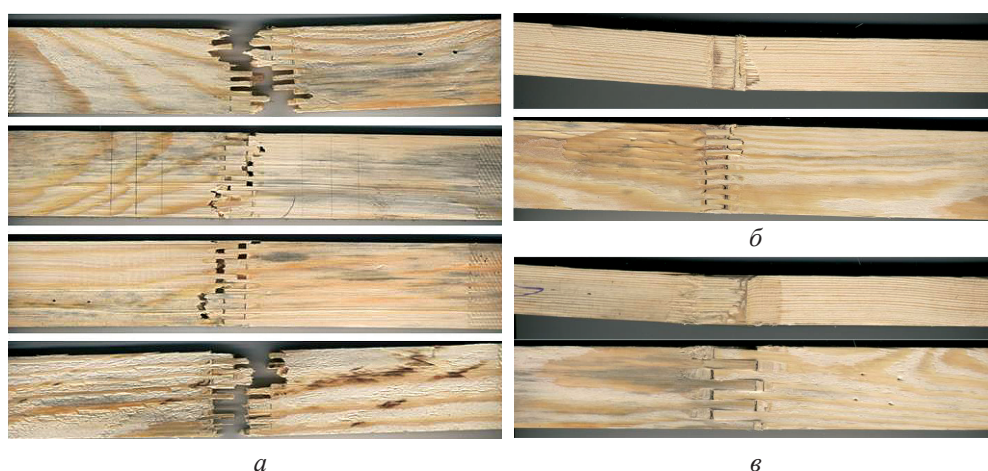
Примеры разрушения образцов двух типоразмеров в результате испытаний на растяжение (*a*) и изгиб (*б*, *в*): *a*, *б* – типоразмер А; *в* – типоразмер Б (вид сбоку и сверху)
